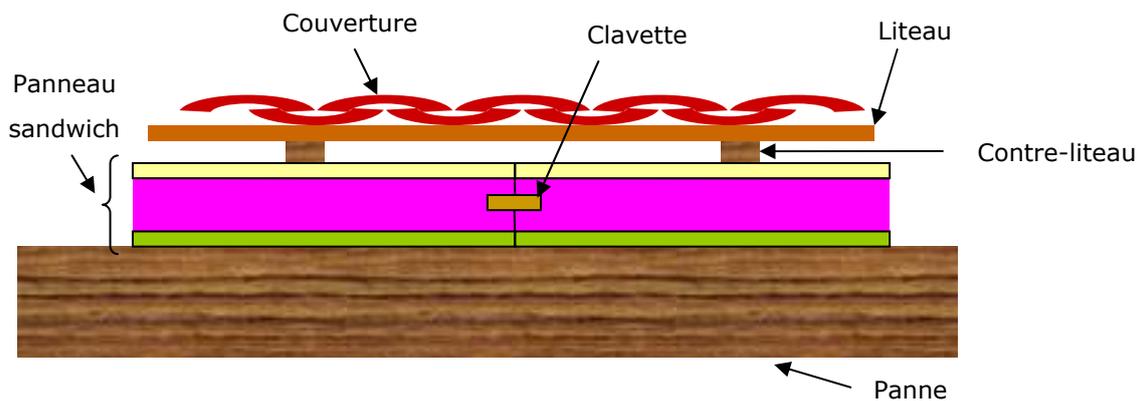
Exemple de schéma d'isolation thermique de toiture par l'extérieur : Panneau sandwich
